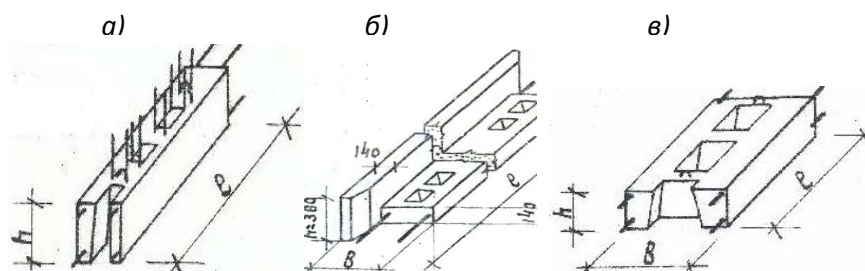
Сборный переемычный (а) и поясной (б) блок поясов наружных и (в) внутренних стен зданий 102 серии [20].
